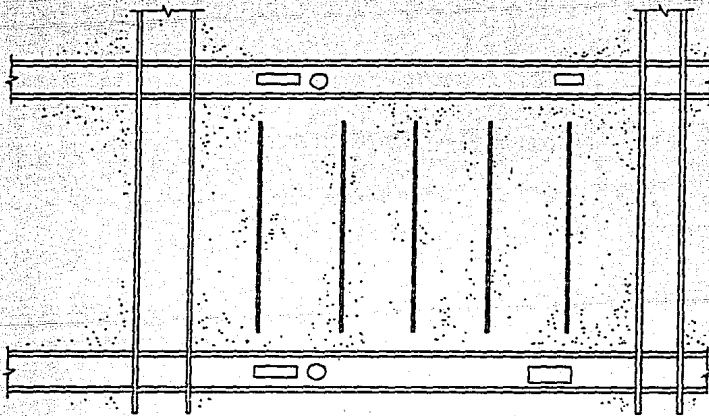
MURO DE CONCRETO PARA CORTANTE CON ABERTURAS
